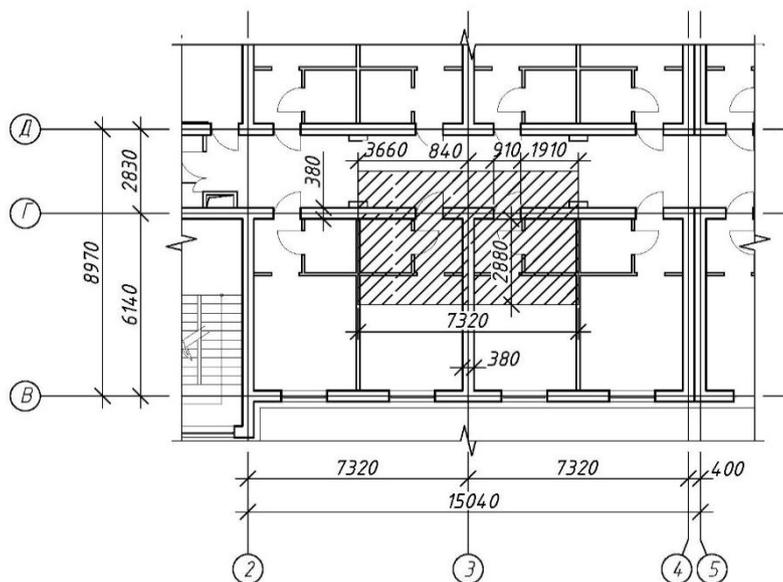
Нагрузка на грузовую площадь от жилой части развлекательно-гостиничного комплекса
